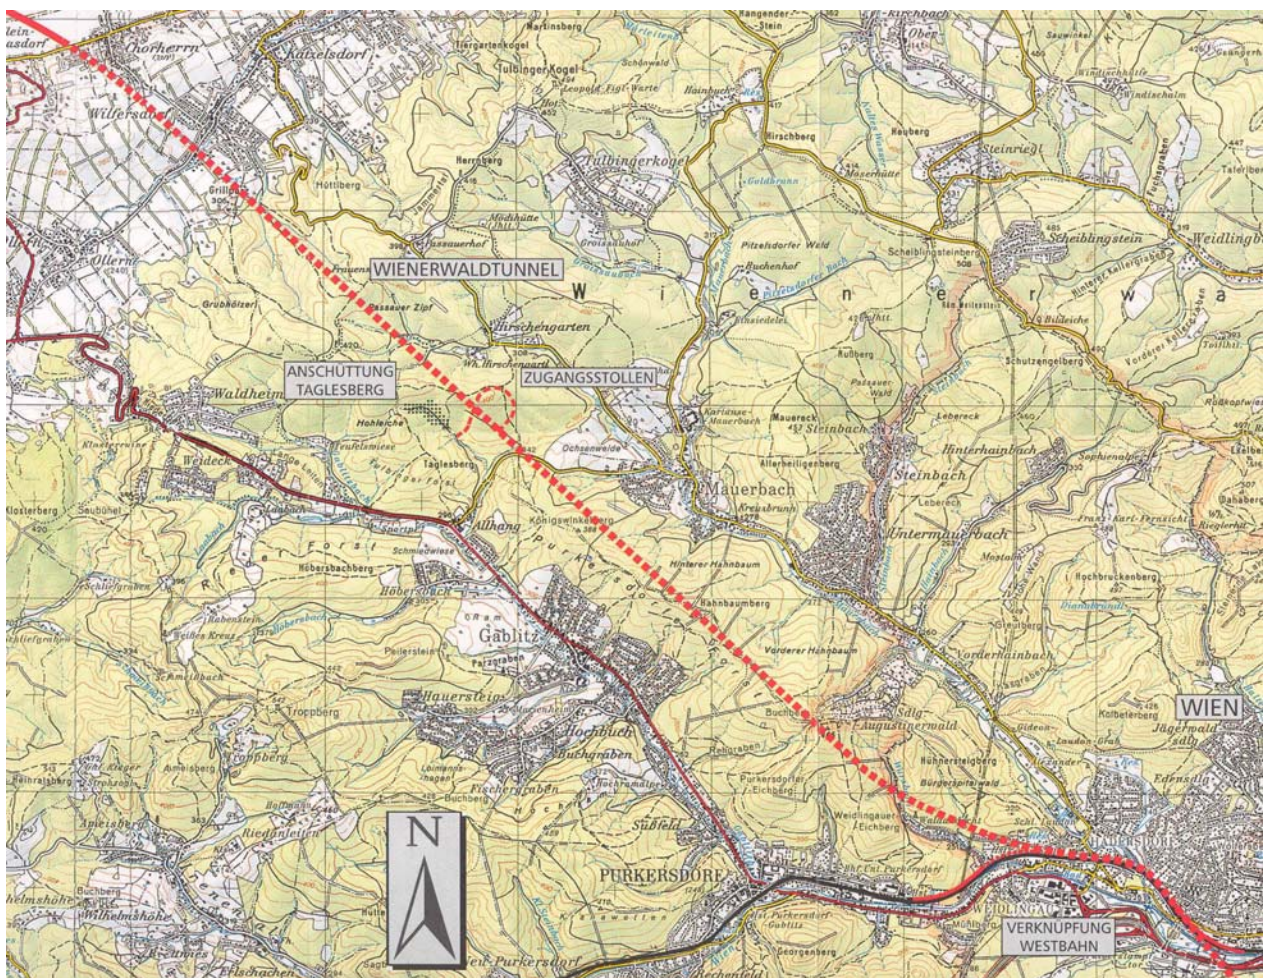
Lageplan des Wienerwaldtunnels der NBS Wien-St.Pölten
